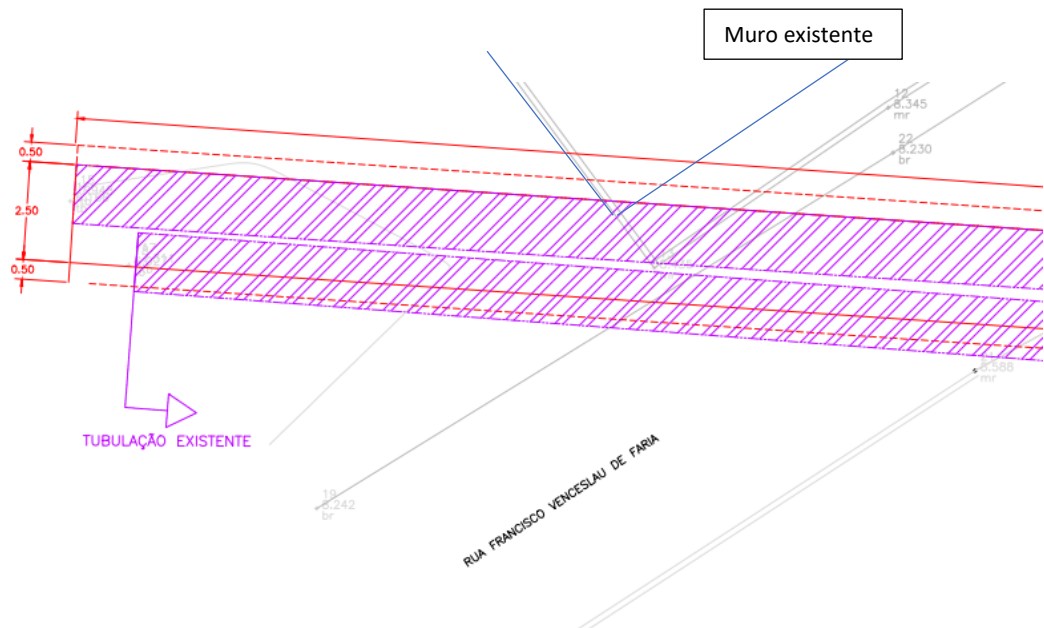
Projeto da galeria e contenção provisória – exemplo de demolição de muros existente
